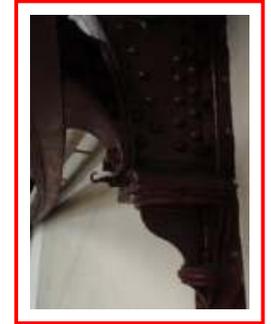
Detalhe do trilho onde o Panorama ficava suspenso.
